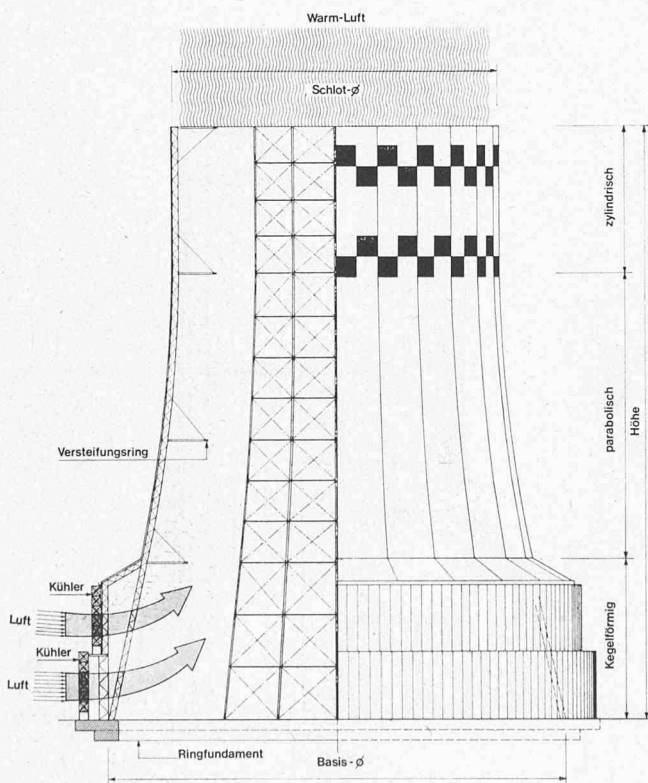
Naturzug-Trockenkühlturm in Stahlfachwerkkonstruktion mit Aluminiumverkleidung, Typ Alesa
